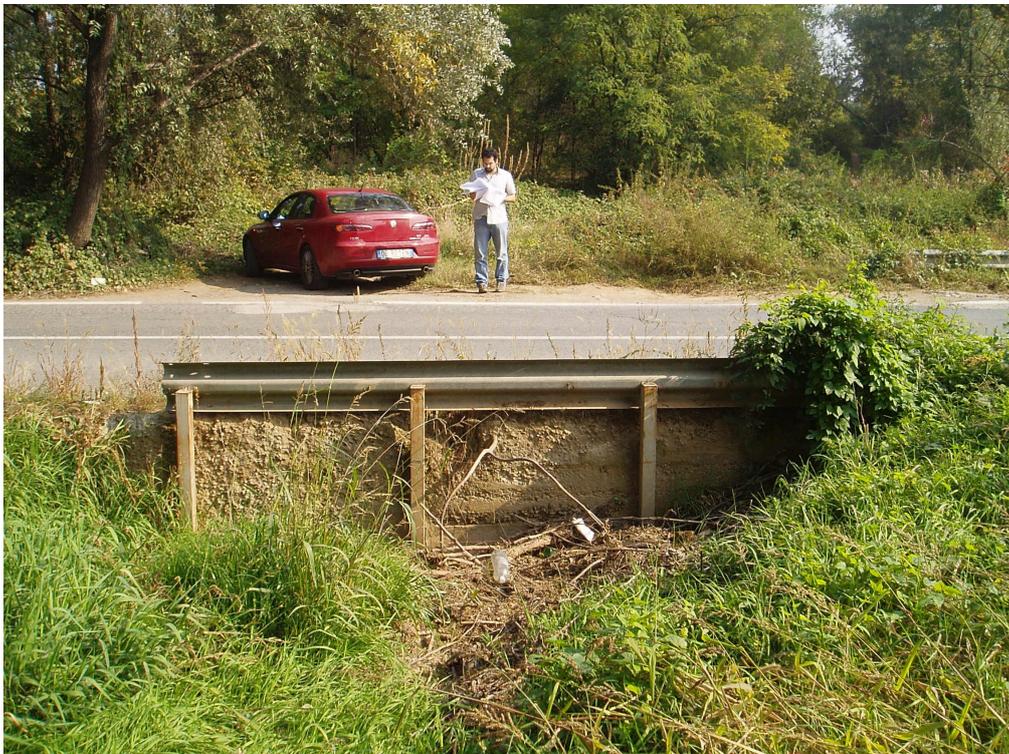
Bealera San Luigi – Attraversamento della strada di accesso all'ospedale (situazione dell'ottobre 2008; documentazione allegata al SICOD di Orbassano)) (foto 923-PA100025)
